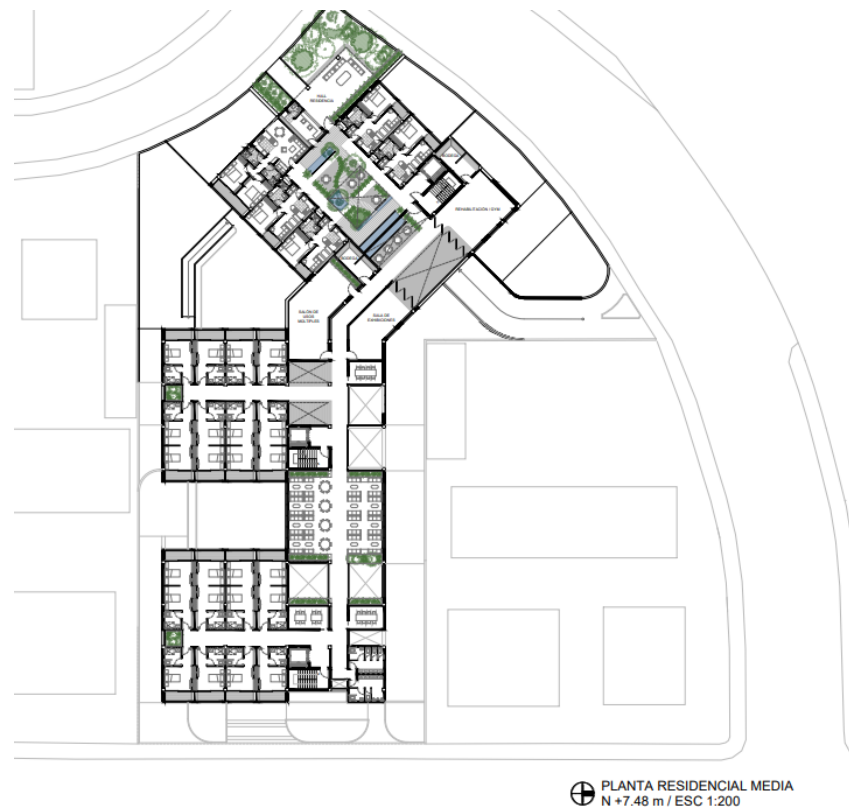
Planimetría: Planta Residencial Media (N +7.48 m)
